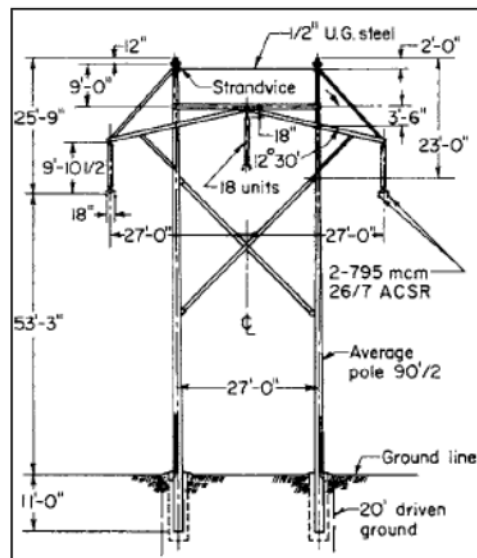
ESTRUCTURA DE MADERA TIPO K
